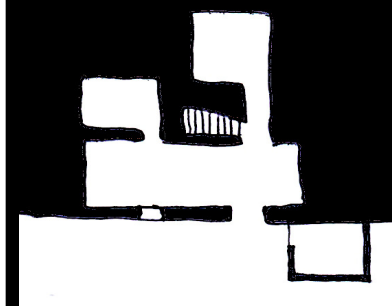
Planta esquemática de habitação subterrânea com acrescento
